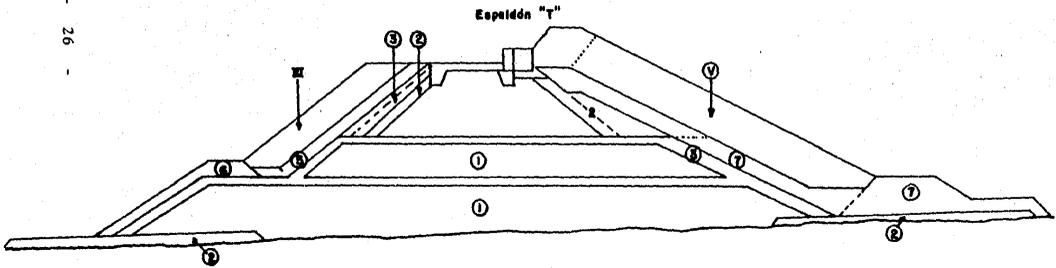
Tipo de roca y bloques de concreto en sección VIII
